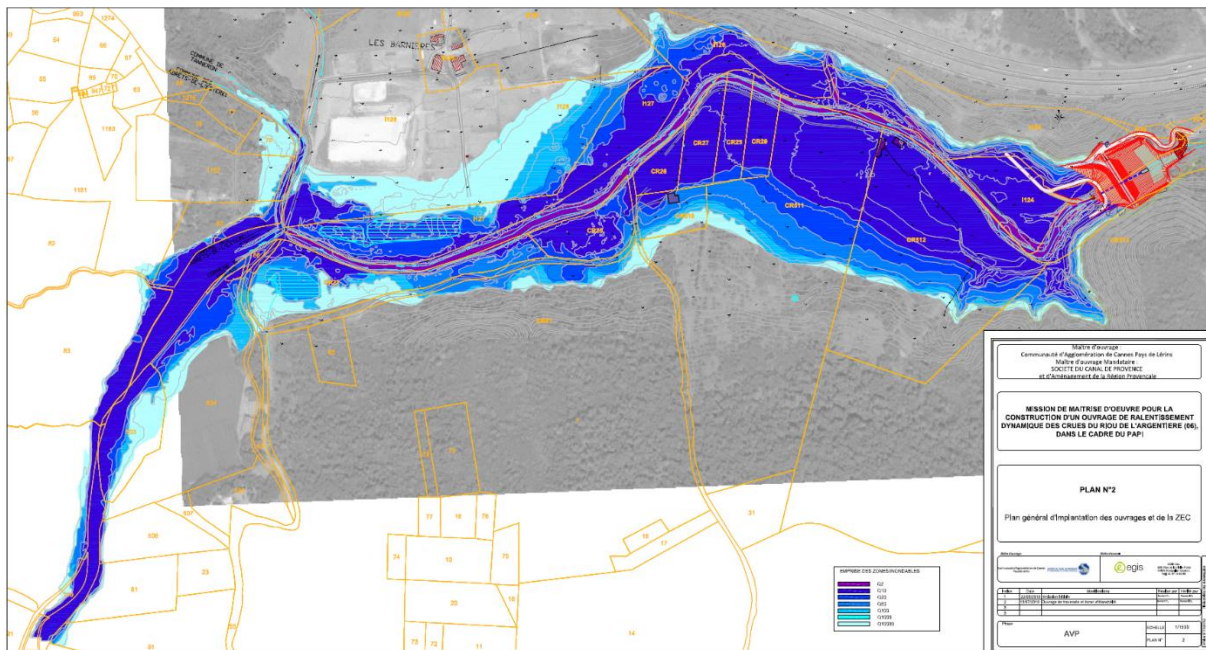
Plan d'implantation général des ouvrages et de la ZEC
